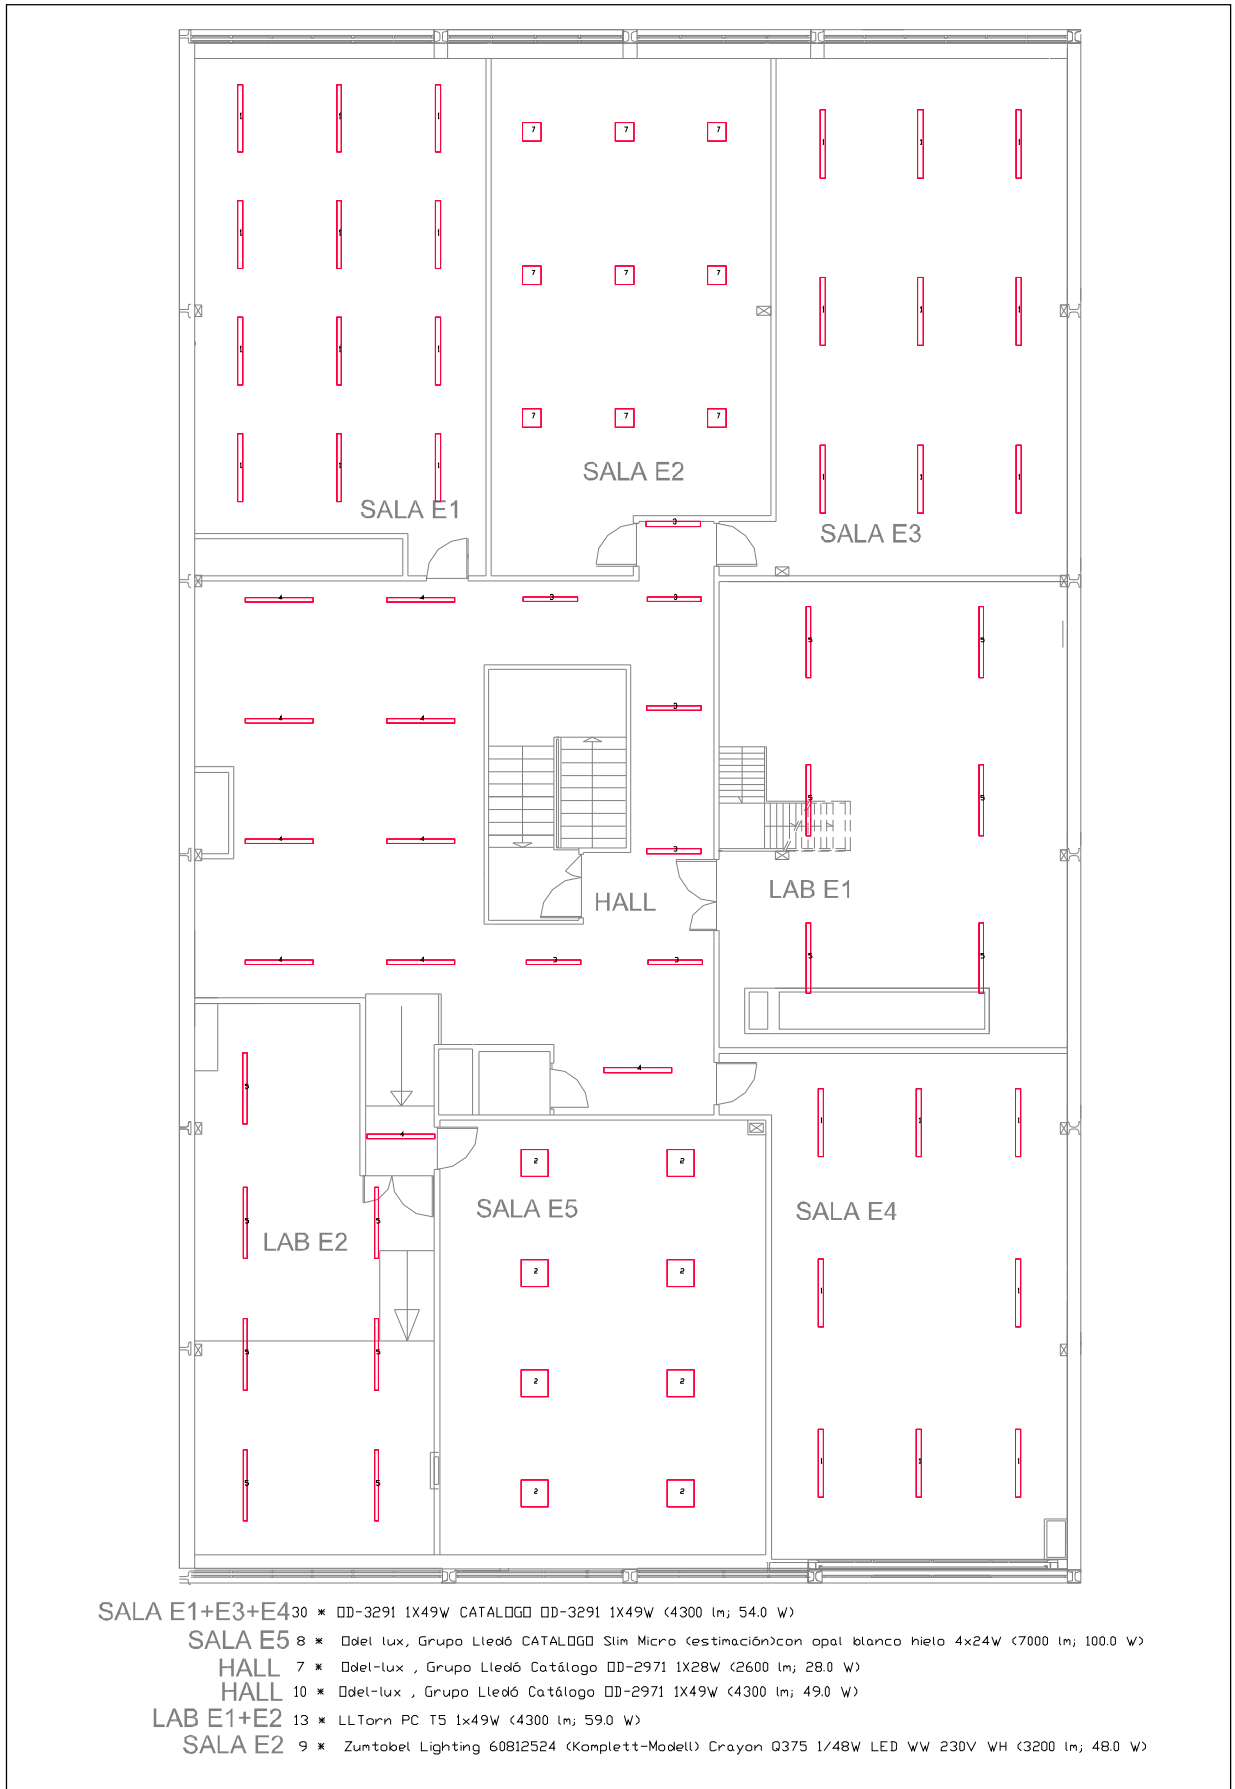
Planta com distribuição das iluminarias do Piso 1
